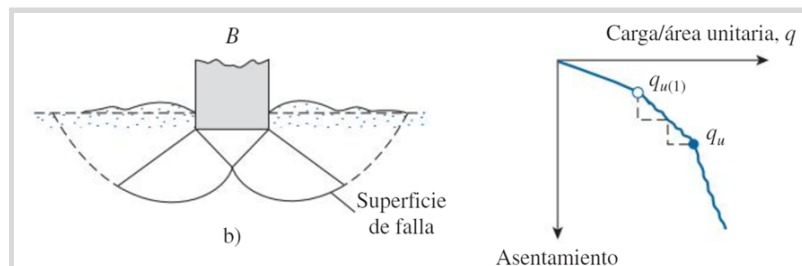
Falla por corte general. Fuente: Fundamentos de ingeniería de cimentaciones Braja M. Das 2012 [17].
